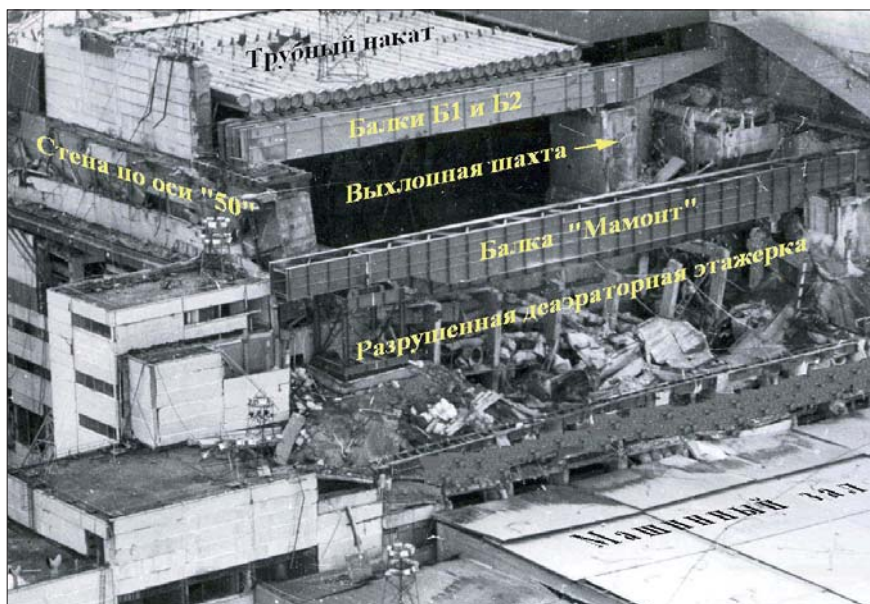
Основные балки, поддерживающие кровлю «Укрытия» и трубный накат
